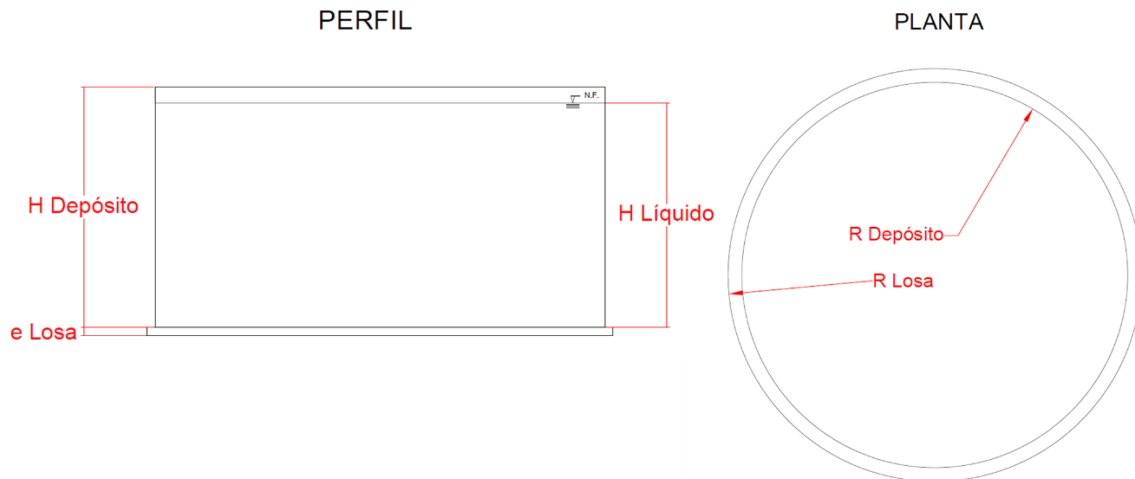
Croquis de planta y perfil de depósito de base circular.
